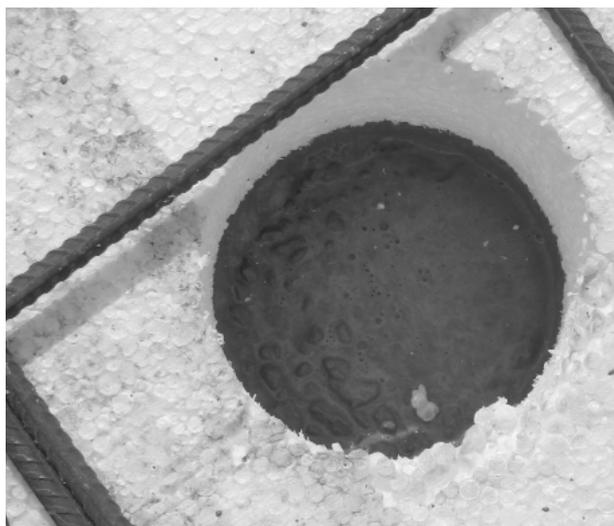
Контроль заполнения бетонной смесью нижней зоны плиты перекрытия с пустотами в виде призм пенополистирола
